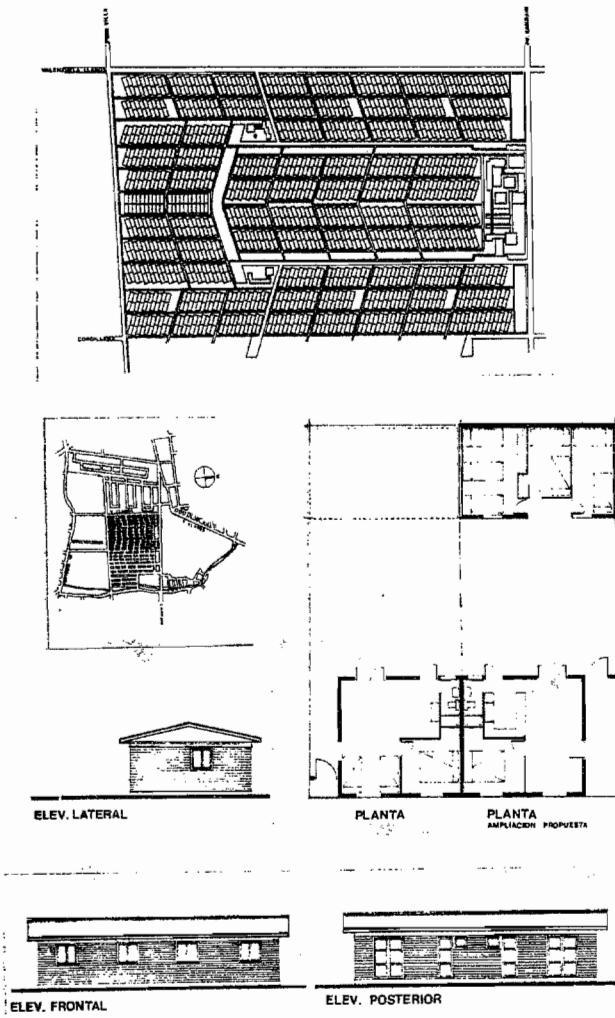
Planimetría del proyecto Población Villa La Reina.
